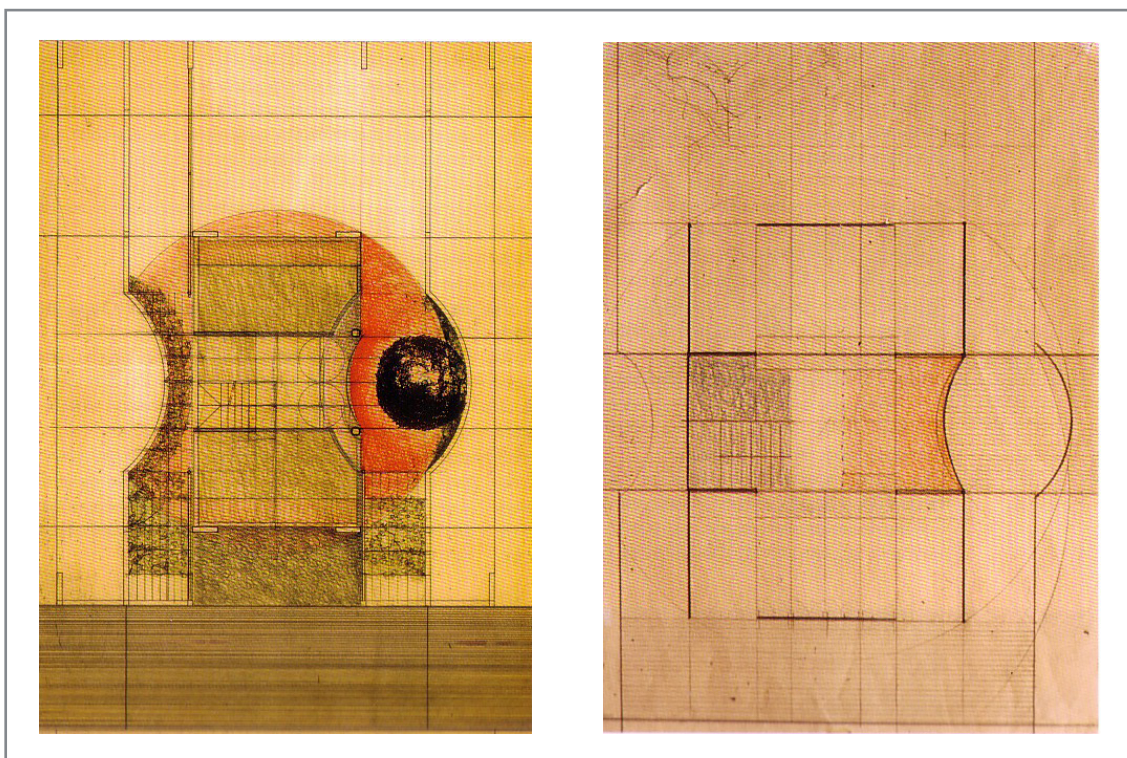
Planta general de ordenación. Fuente:Revista Obradoiro Nº18 (1991)
